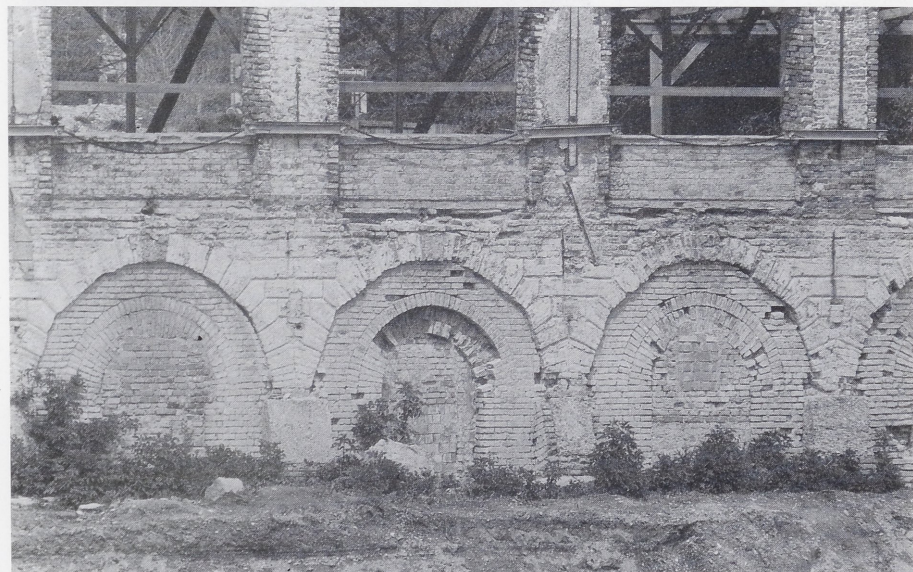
München, Hofgarten, Arkadengebäude. Detail mit Rustizierung des 16. Jh. (Diemer)
